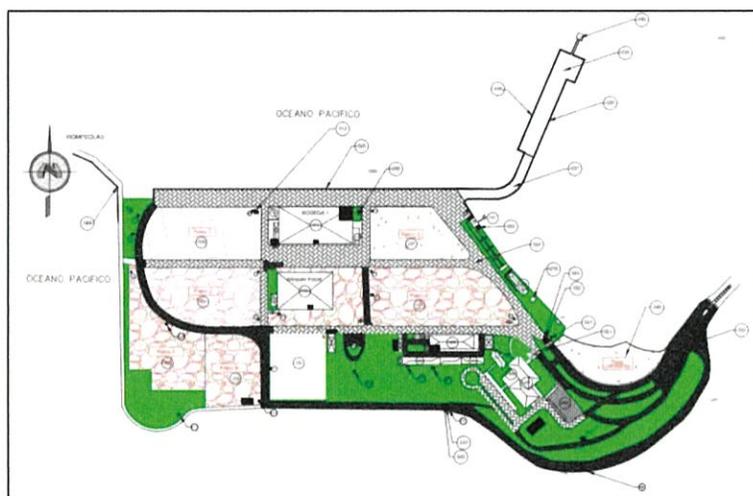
Plano en planta con identificadores de la infraestructura de Puerto Caldera
